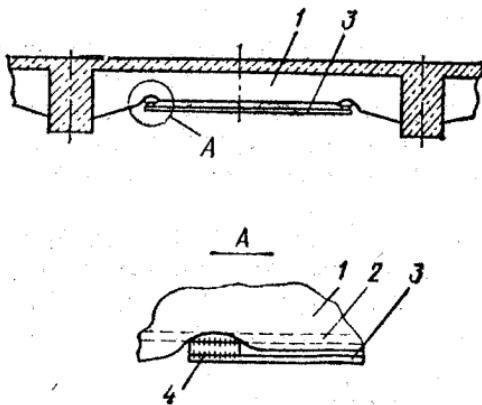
Усиление балки на локальном участке предварительно напряженной арматурой:
